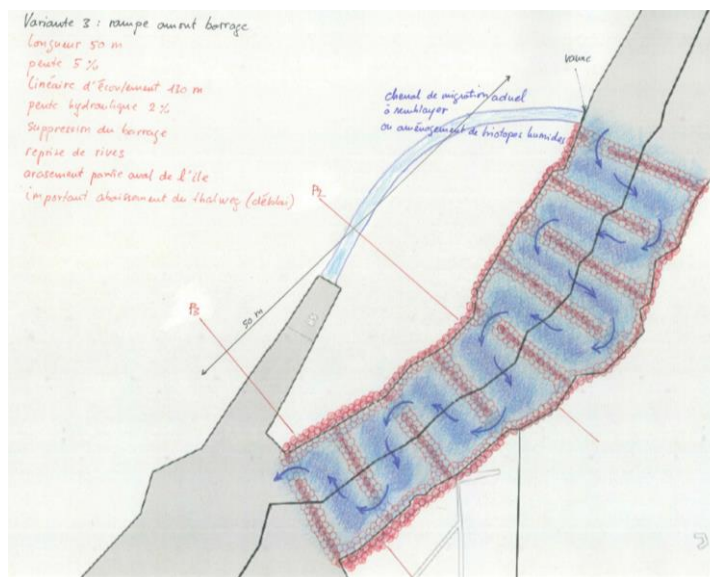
Variante 3 : rampe rugueuse en amont du seuil - croquis en plan
